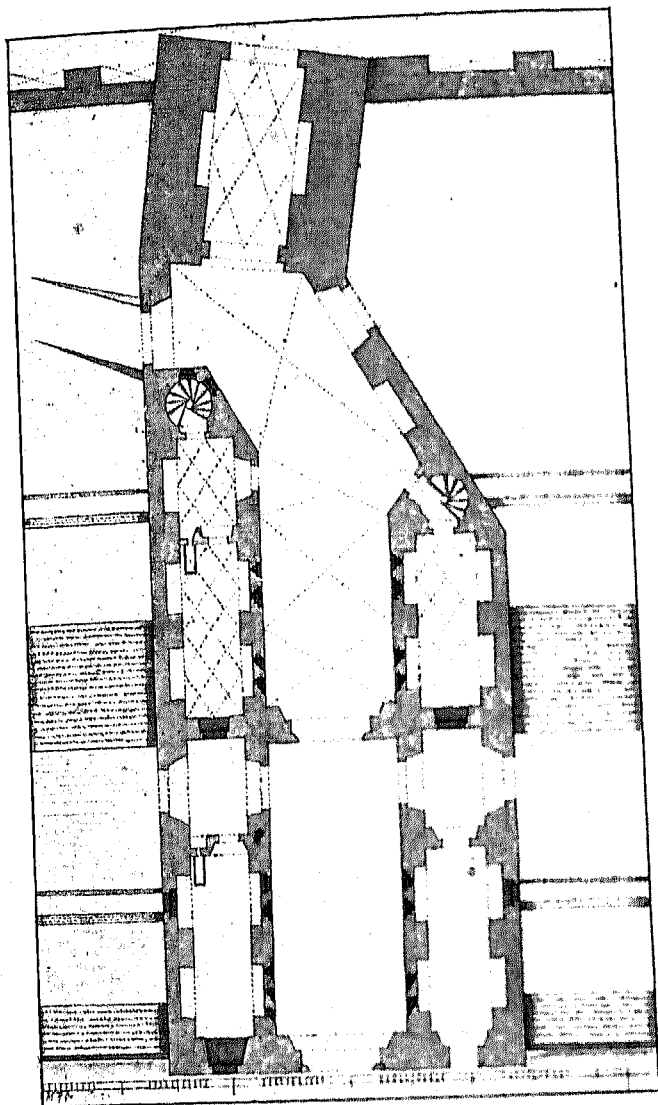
Eschenheimer Thor; Grundriss.
